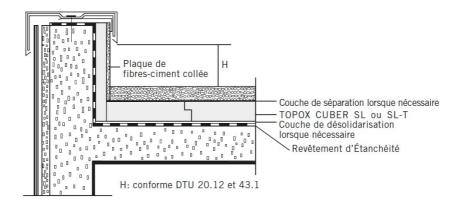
Relevé sur terrasse accessible aux piétons et au séjour avec dalles sur plots
